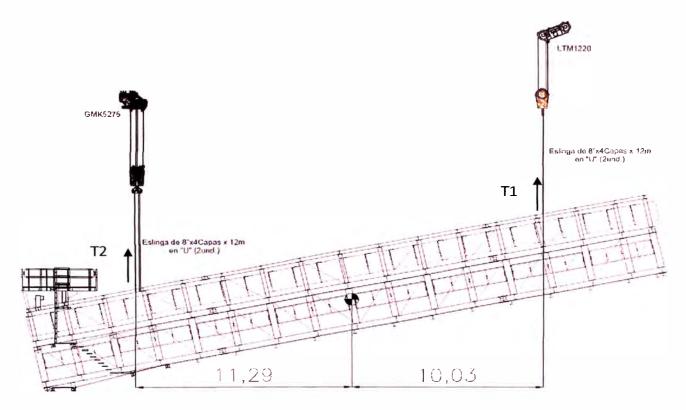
Arreglo de aparejos para el izaje en Tandem
